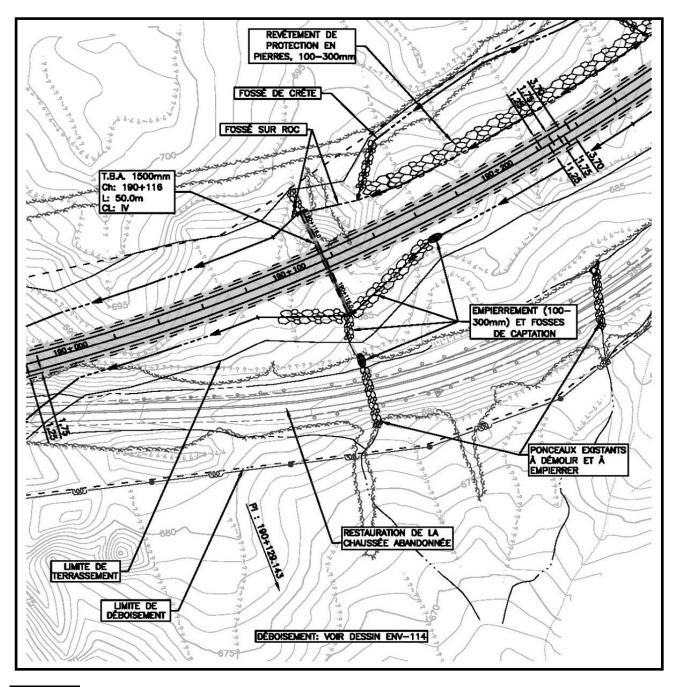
Extrait d'un plan de construction. (2003.1028)
